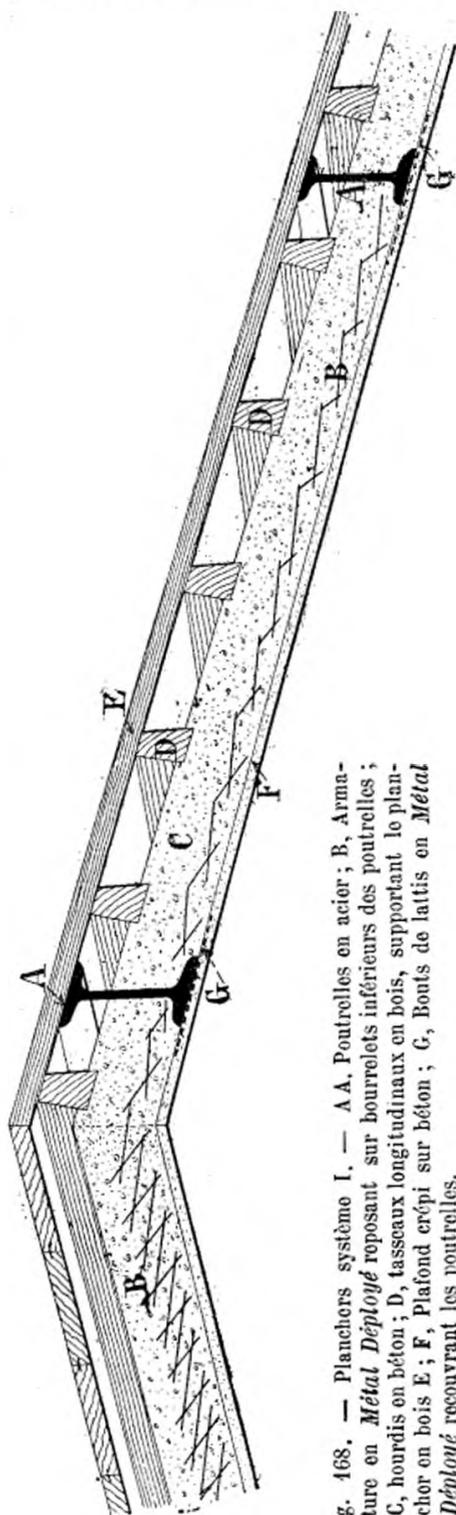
Planchers système I. — A A, Poutrelles en acier; B, Armature en Métal Déployé reposant sur hourrelets inférieurs des poutrelles; C, hourdis en béton; D, tasseaux longitudinaux en bois, supportant le plancher en bois E; F, Plafond crépi sur béton; G, Bouts de lattis en Métal Déployé recouvrant les poutrelles.
